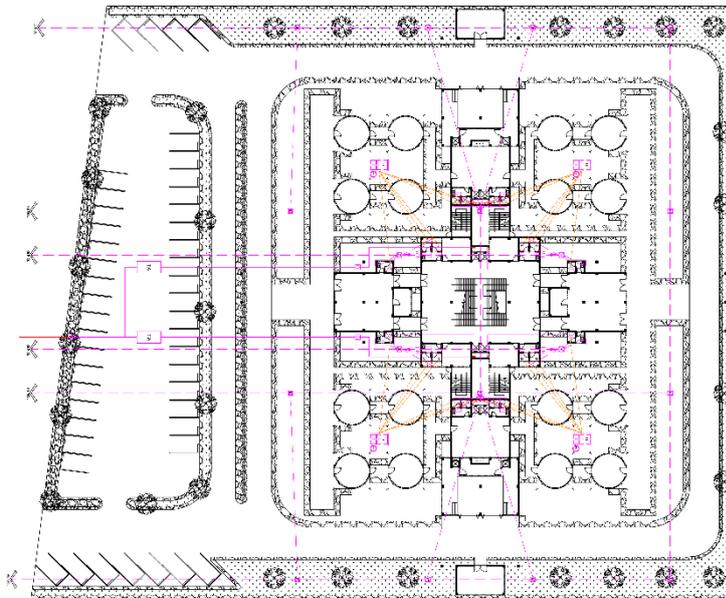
Instalasi Listrik Lantai 4 (Penulis, 2018)
